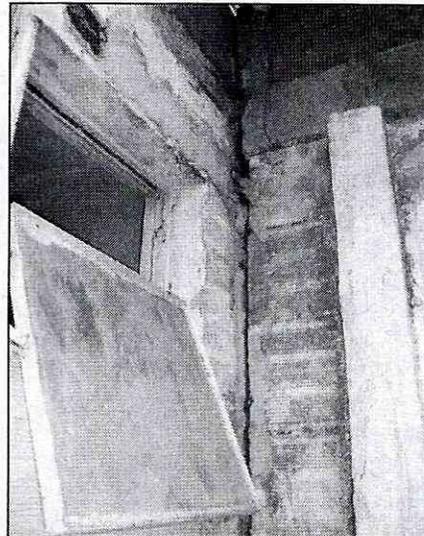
Fotografía 4. Abertura entre una las dilataciones constructivas de las viviendas de la urbanización, nótese que hacia la derecha la vivienda tiene tres niveles y hacia esta vivienda es donde se presenta la inclinación de la abertura
